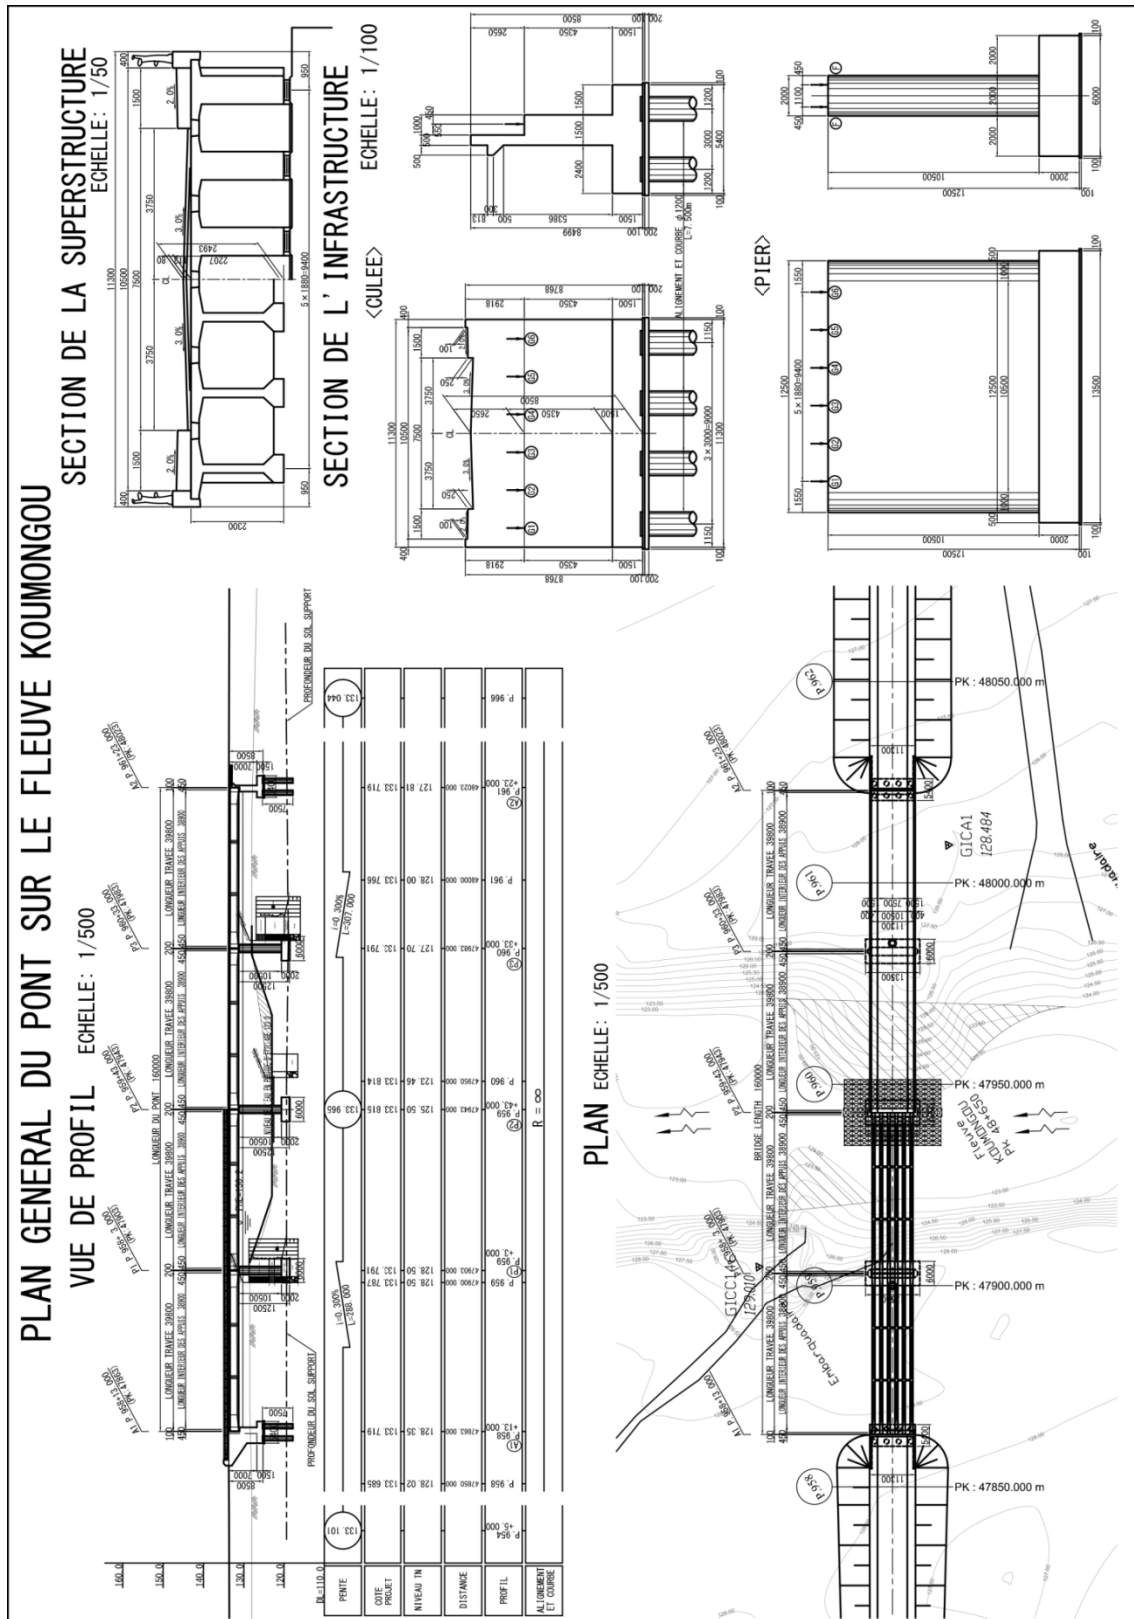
Plan général du pont sur le fleuve Koumongou
